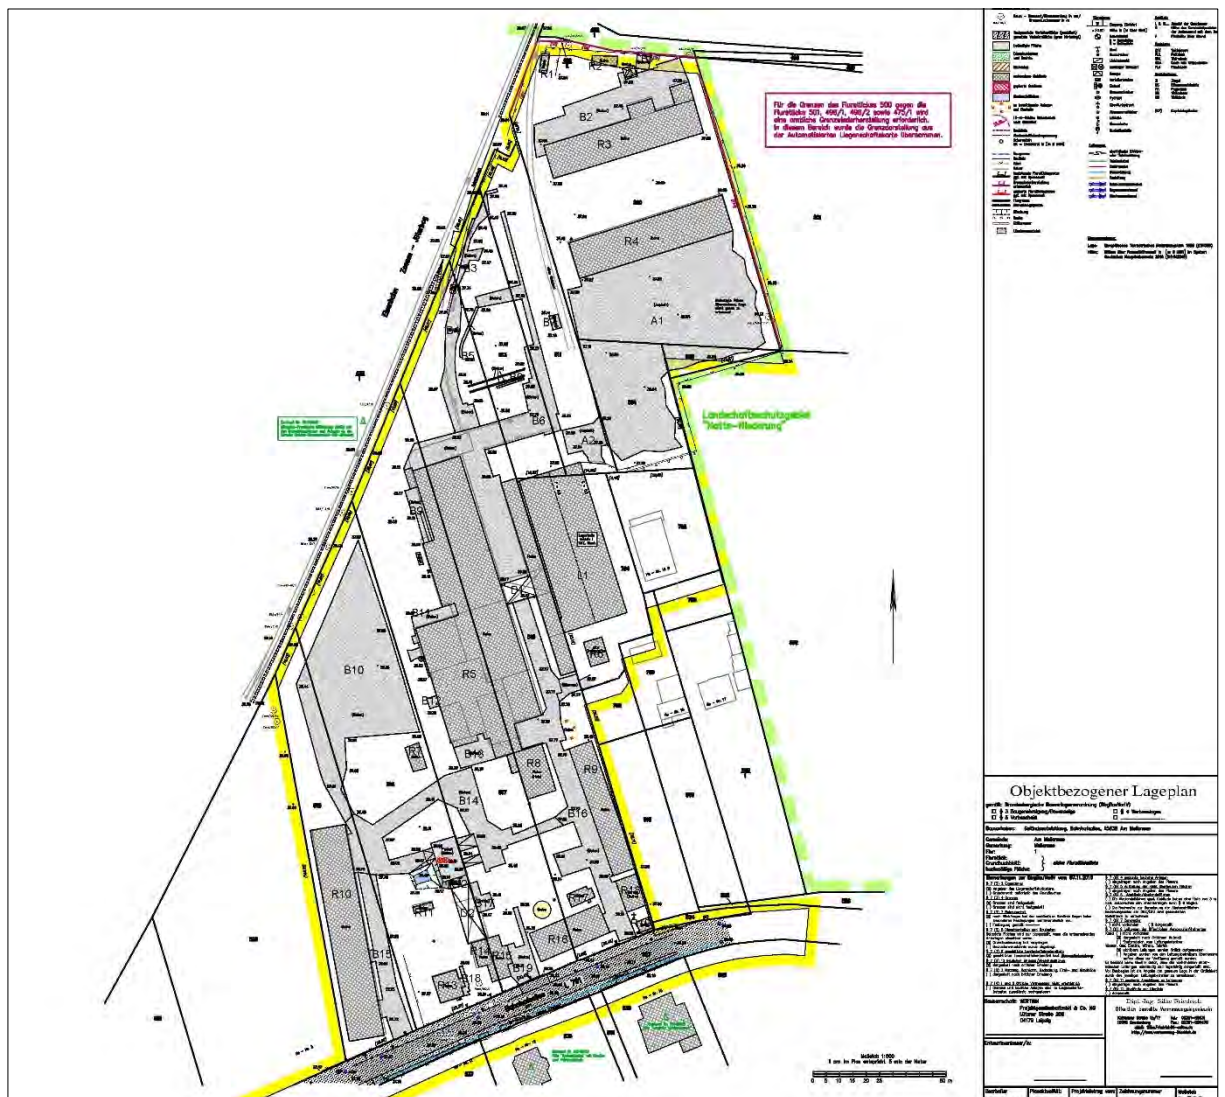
Objektbezogener Lageplan der ÖbVI Dipl.-Ing. Silke Friedrich vom 06.06.2019 für die Grundstücke Bahnhofsallee 13 und 16 B in Mellensee
